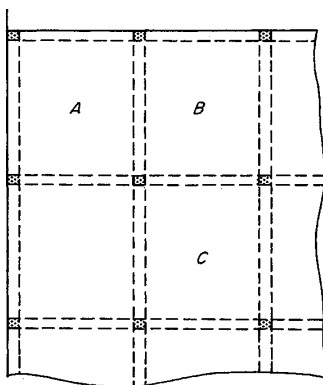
Planta de una losa de piso común armada en dos direcciones con vigas en los ejes de columnas
